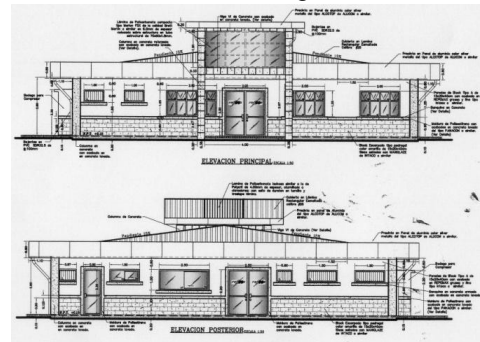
Fachada principal y posterior del centro médico del plantel de El Alto. (Fuente: Ingeniería Recope)
